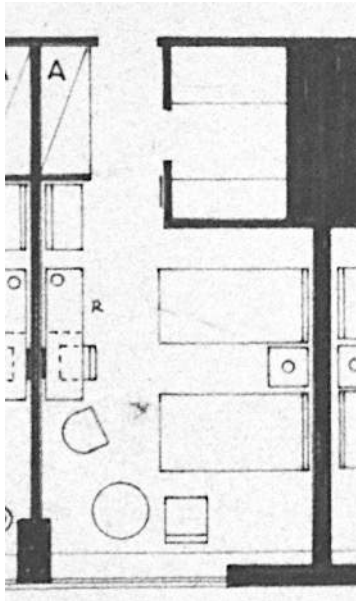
Grundriss Zimmertyp „Conventional“
